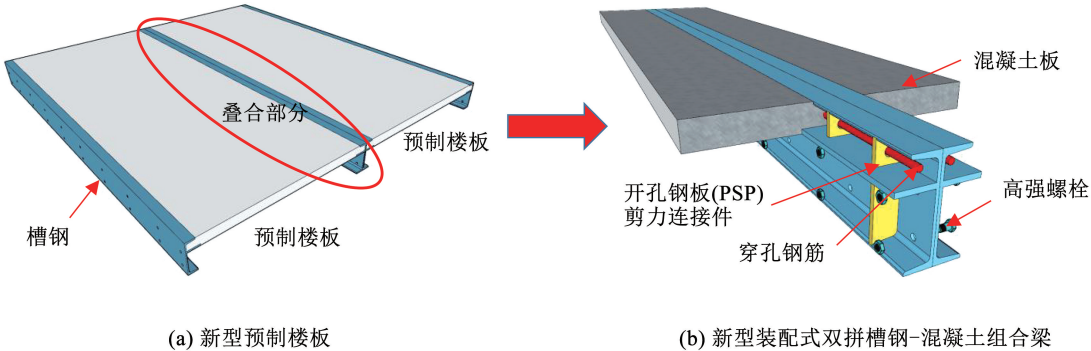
新型预制楼板及双拼槽钢-混凝土组合梁
